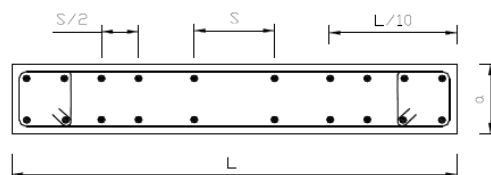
Disposition des armatures verticales dans les voiles
